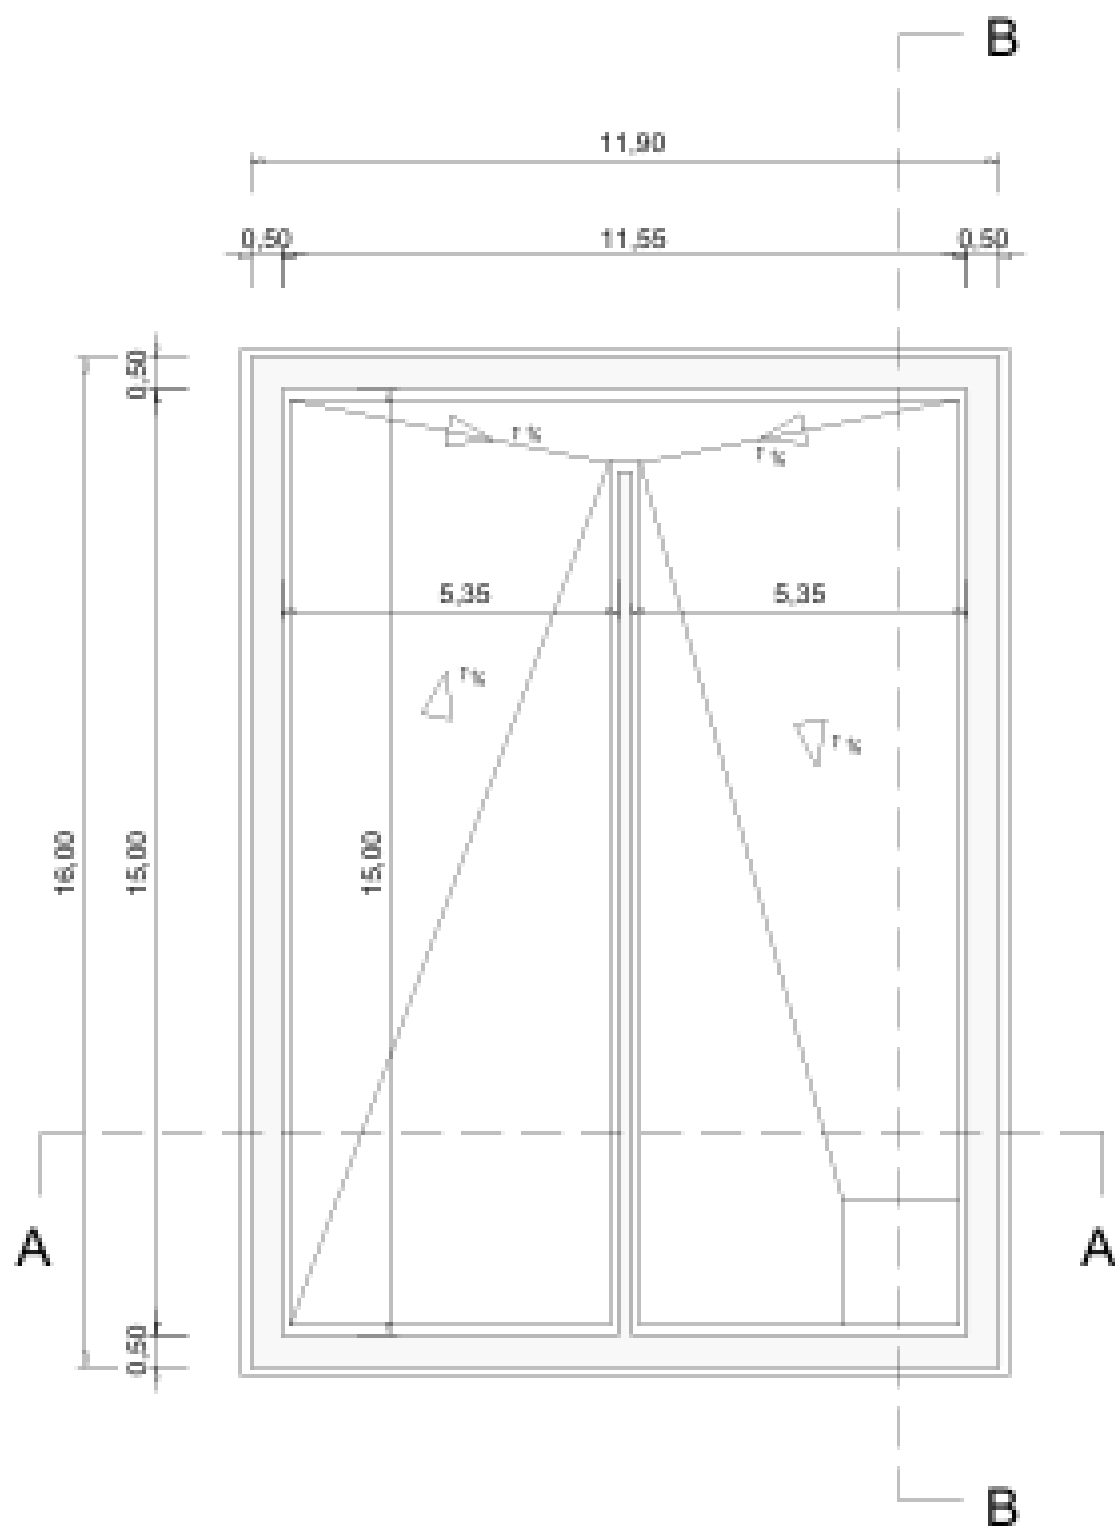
Tavola progetto PC.06 – Serbatoio di accumulo. Planimetria
